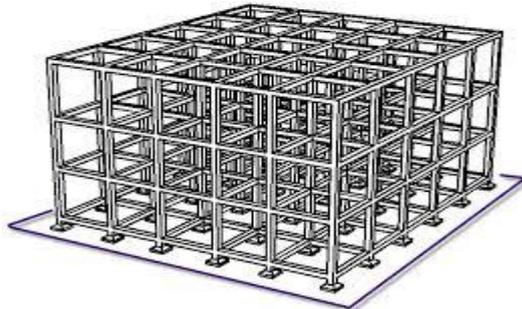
sistem pondasi foot plat dan pondasi menerus
